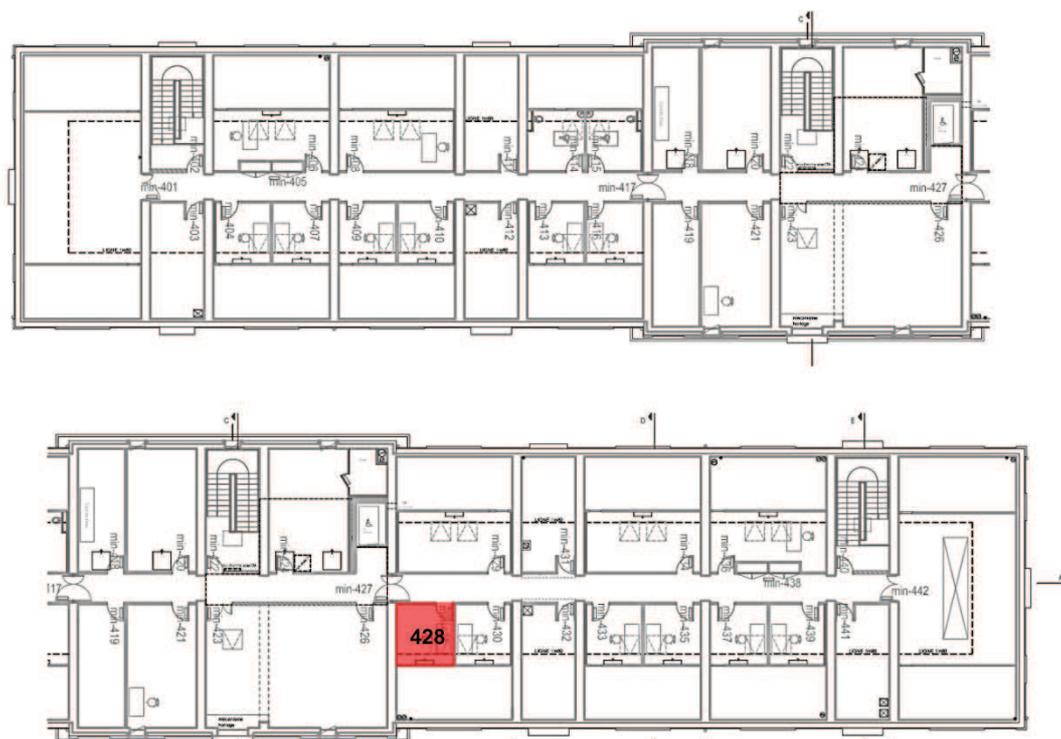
Plan du bâtiment SJA3 du campus Saint Jean d'Angely (4^{ème} étage)
